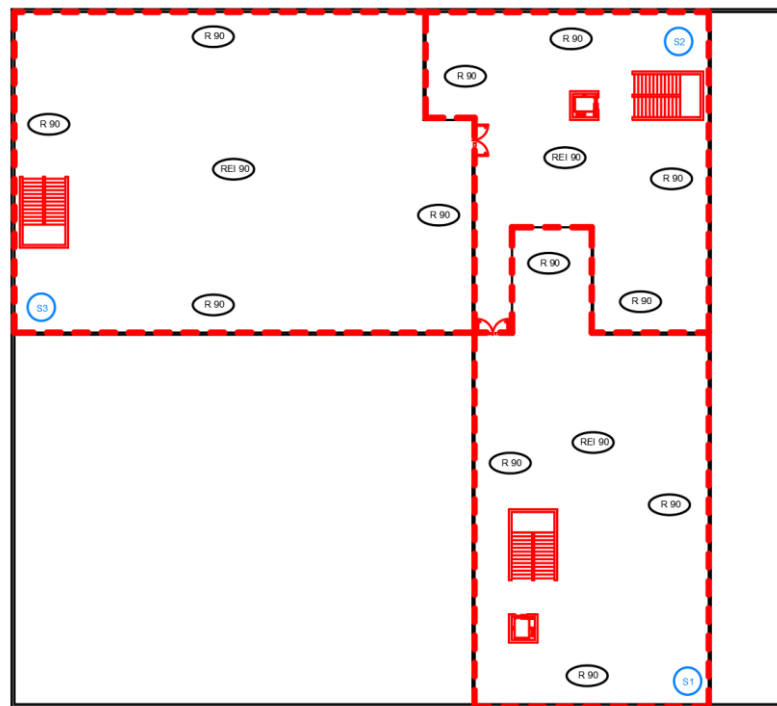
Resistencia al fuego de la estructura portante proyectada para la primera planta, y el forjado de losa alveolar.
